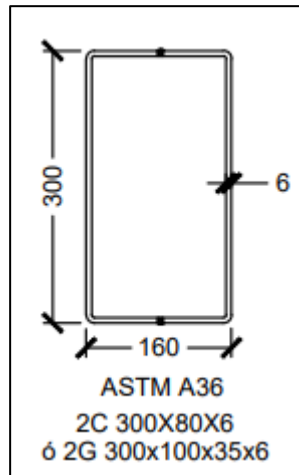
Sección viga transversal (Segura, A. & Vélez, F., 2020)
